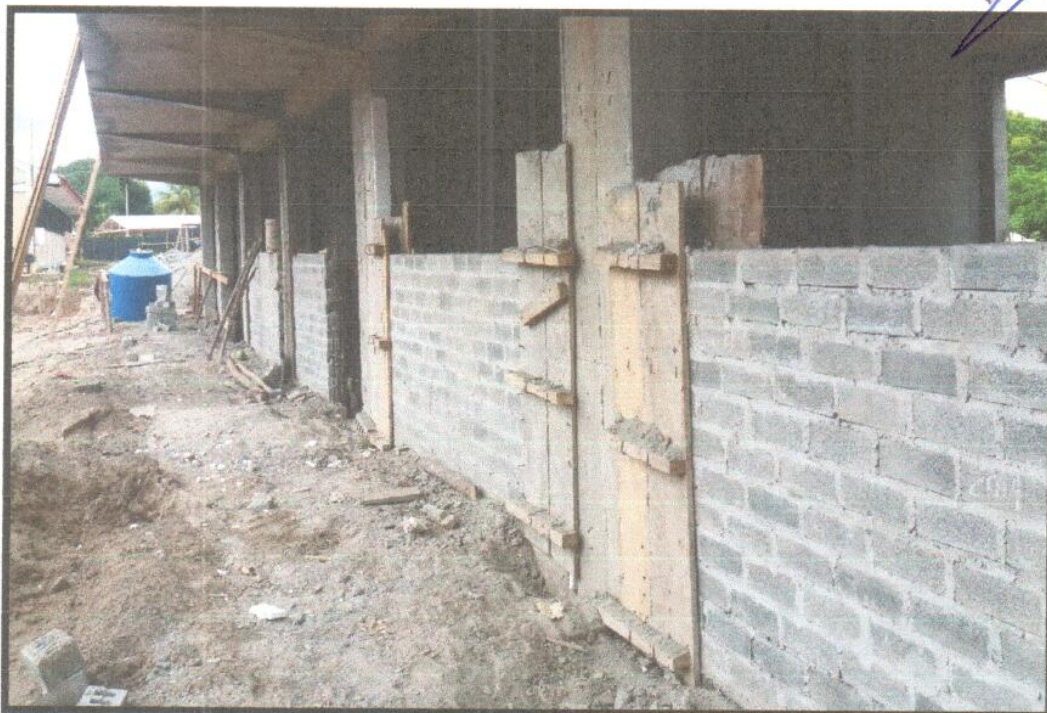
MURO DE LADRILLO KK TIPO IV SOGA. MODULO 04
